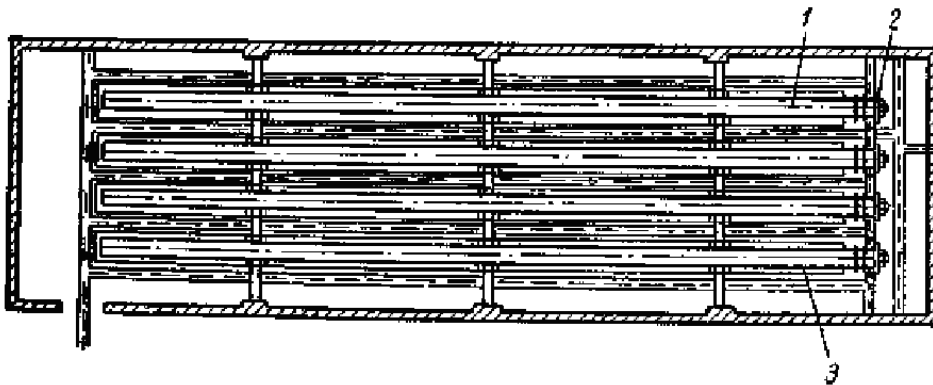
Камера охолодження м'яса з міжшляховими повітроохолоджувачами з гладких труб: 1 – повітроводи з соплами; 2 – вентилятори з електродвигунами; 3 – батареї
